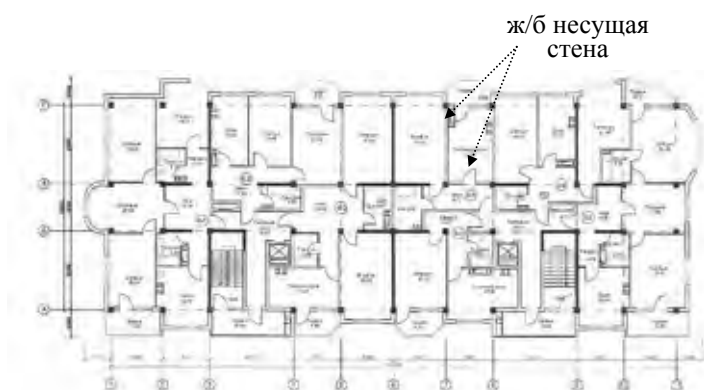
Типовой поэтажный план 9-ти этажного жилого дома с установленными в двух направлениях ж/б несущими стенами (предоставлено КазНИИССА)
